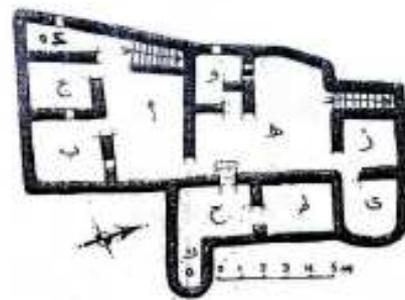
مسقط أفقي للدور الأرضي بدار ببلدة بلاط
